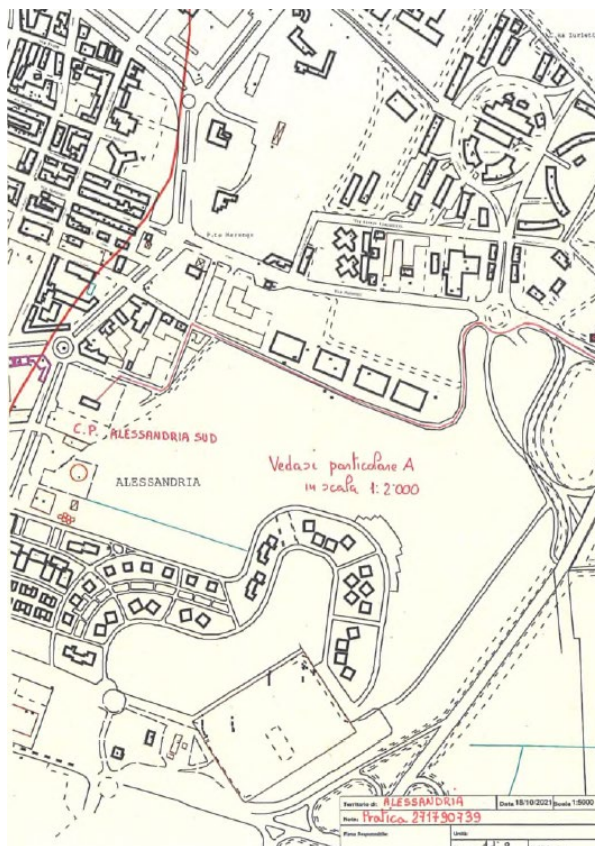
Tracciato cavidotti di connessione alla CP "Alessandria SUD" secondo planimetrie STMG
